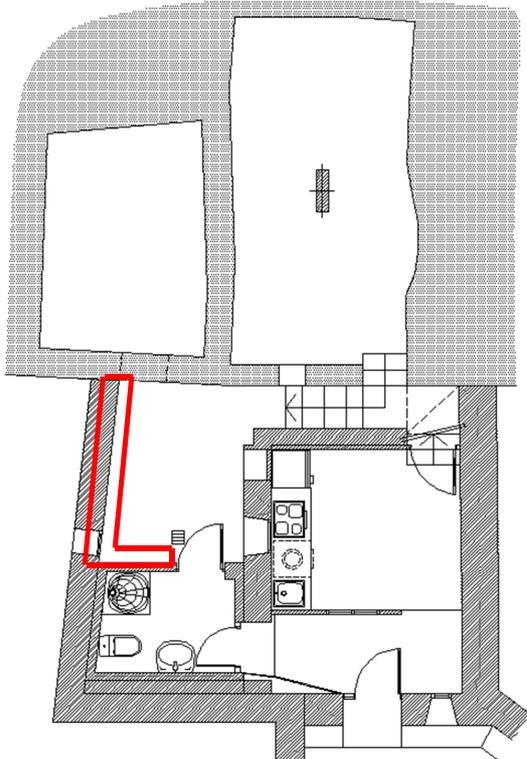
Planta baja y sótano (bodega). Situación de la mancha de humedad en el patio exterior.
